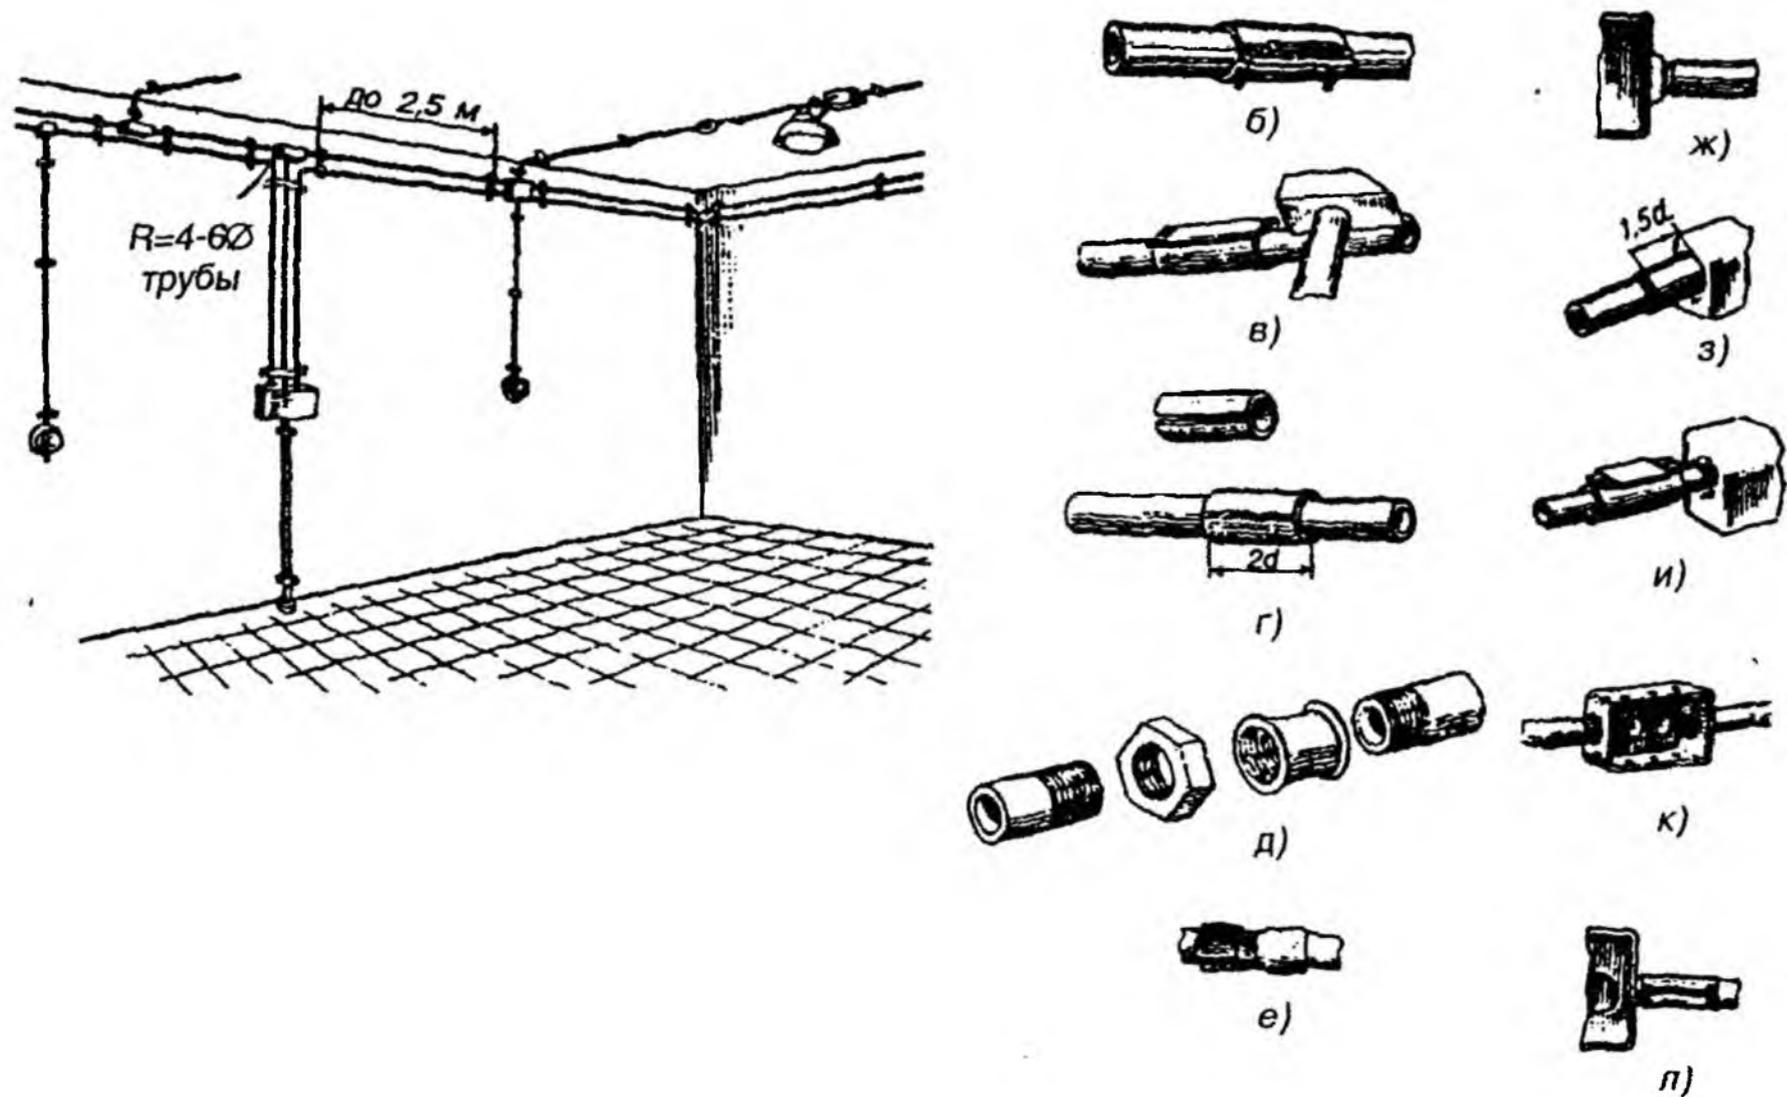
Монтаж электропроводок в стальных трубах:
